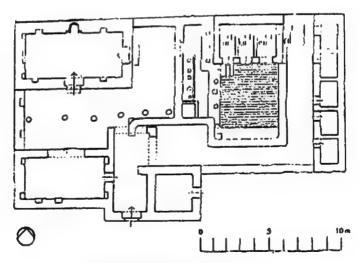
مسقط أفقي للمدرسة الأشرفية بمدينة تعز (عن الأكوع)
